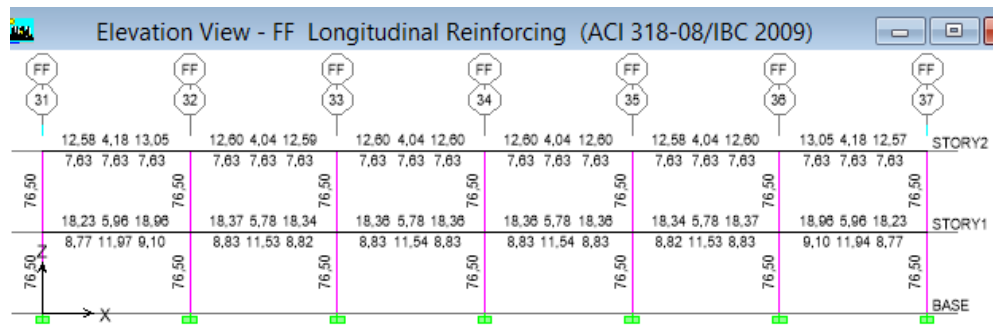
Acero en Vigas y Columnas en el Pórtico FF – Obstetricia - (CEC2002)
